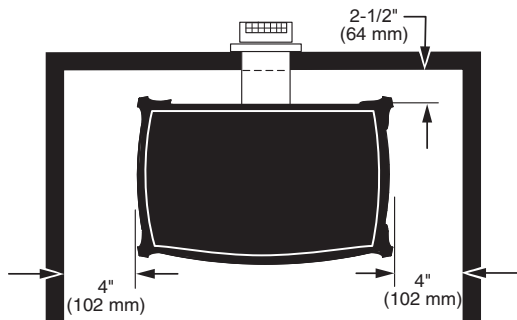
Installation parallèle, dégagements minimaux à l'arrière et sur les côtés.
